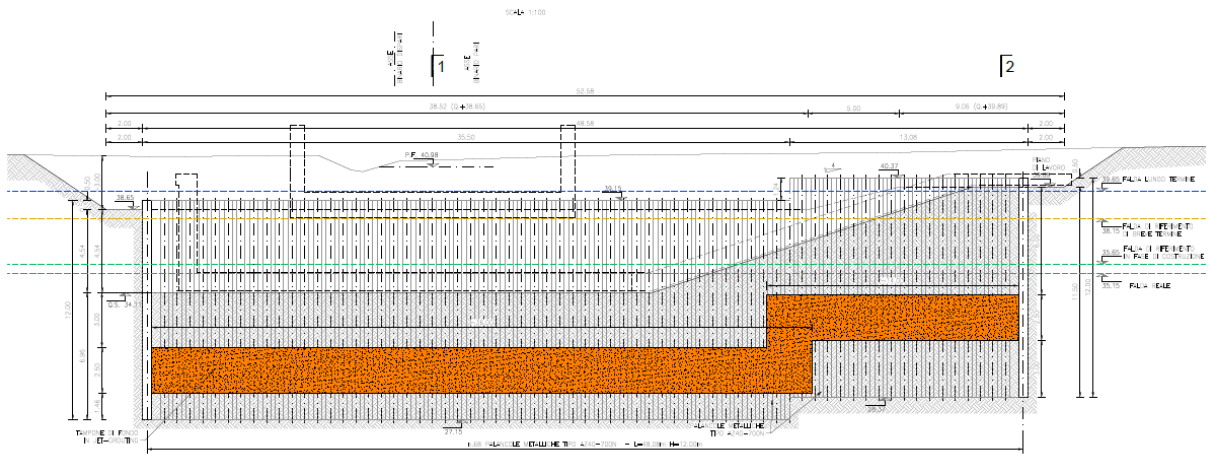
Sezione longitudinale opere provvisionali per costruzione sifone
